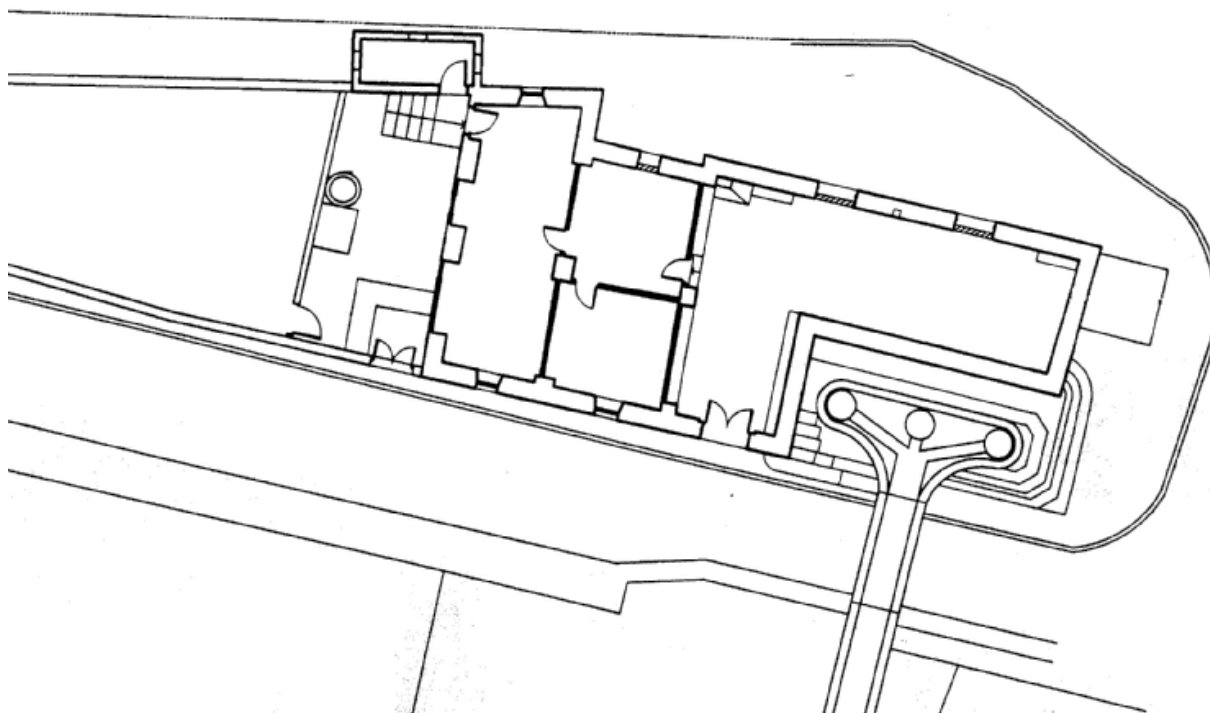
Planta del estado actual del Molino del Lugar, Adra. Plano del autor.
